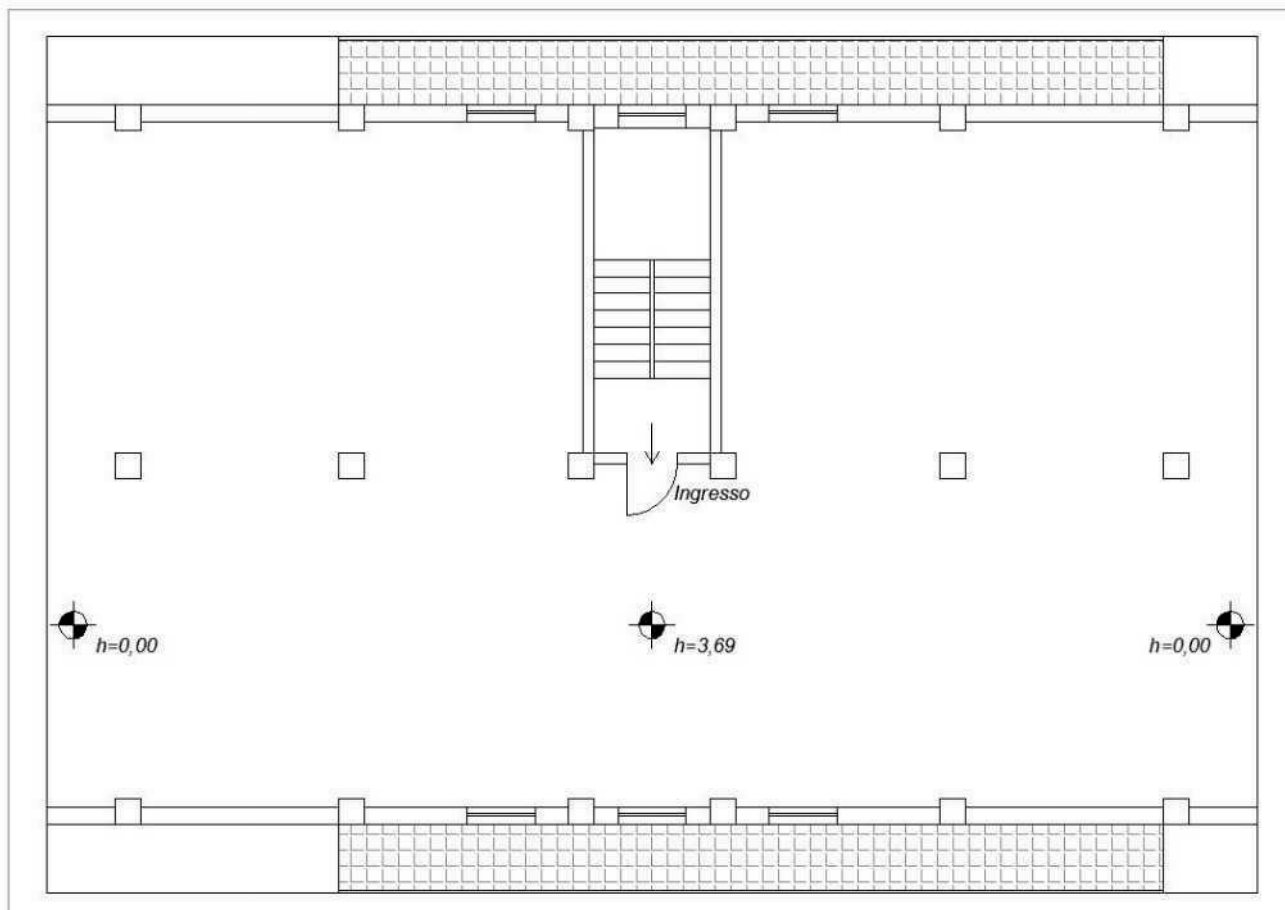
Planimetria del piano sottotetto allo stato attuale
